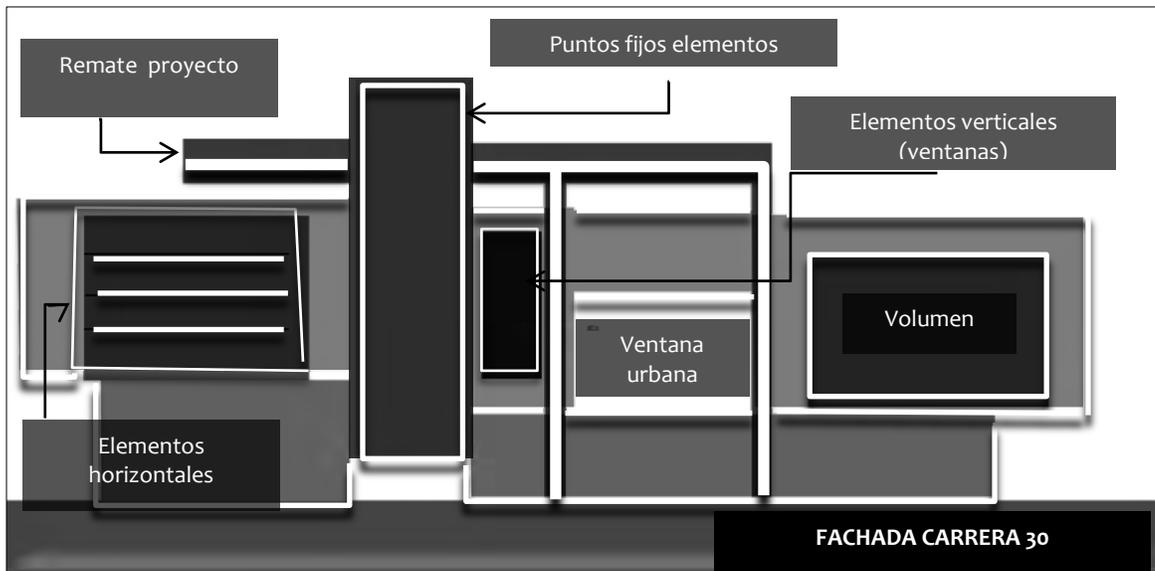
fachada carrera 30 análisis fachadas propuesta /7fuente esta investigación//
